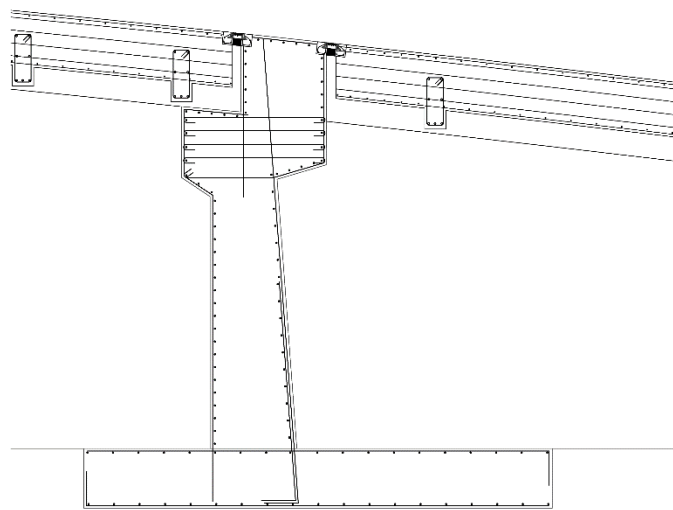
Detalle constructivo de los estribos. Elaboracion propia, (AutoCad).
